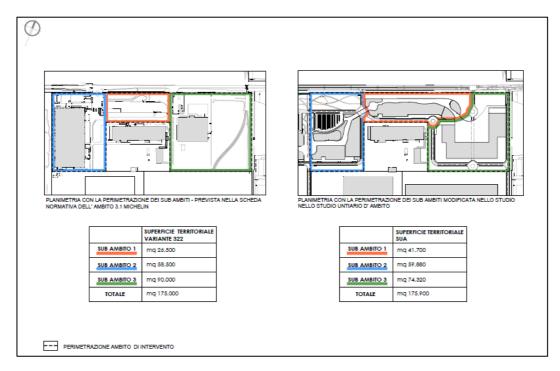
Planimetria generale con indicazione della modifica di perimetrazione dei Sub Ambiti rispetto alla Variante 322
